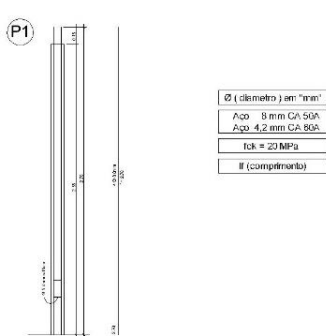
Planta vigas e pilares projeto finalizado concreto armado
